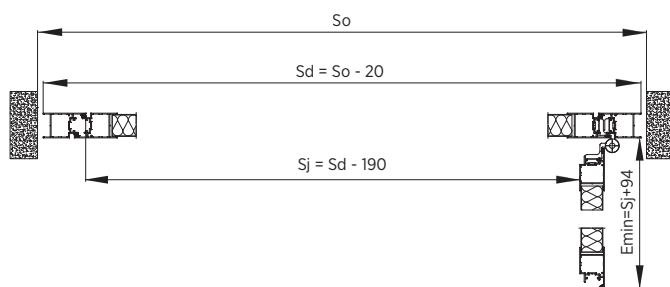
Montaggio in foro - sezione orizzontale - porta a un'anta - sistema AW45.
